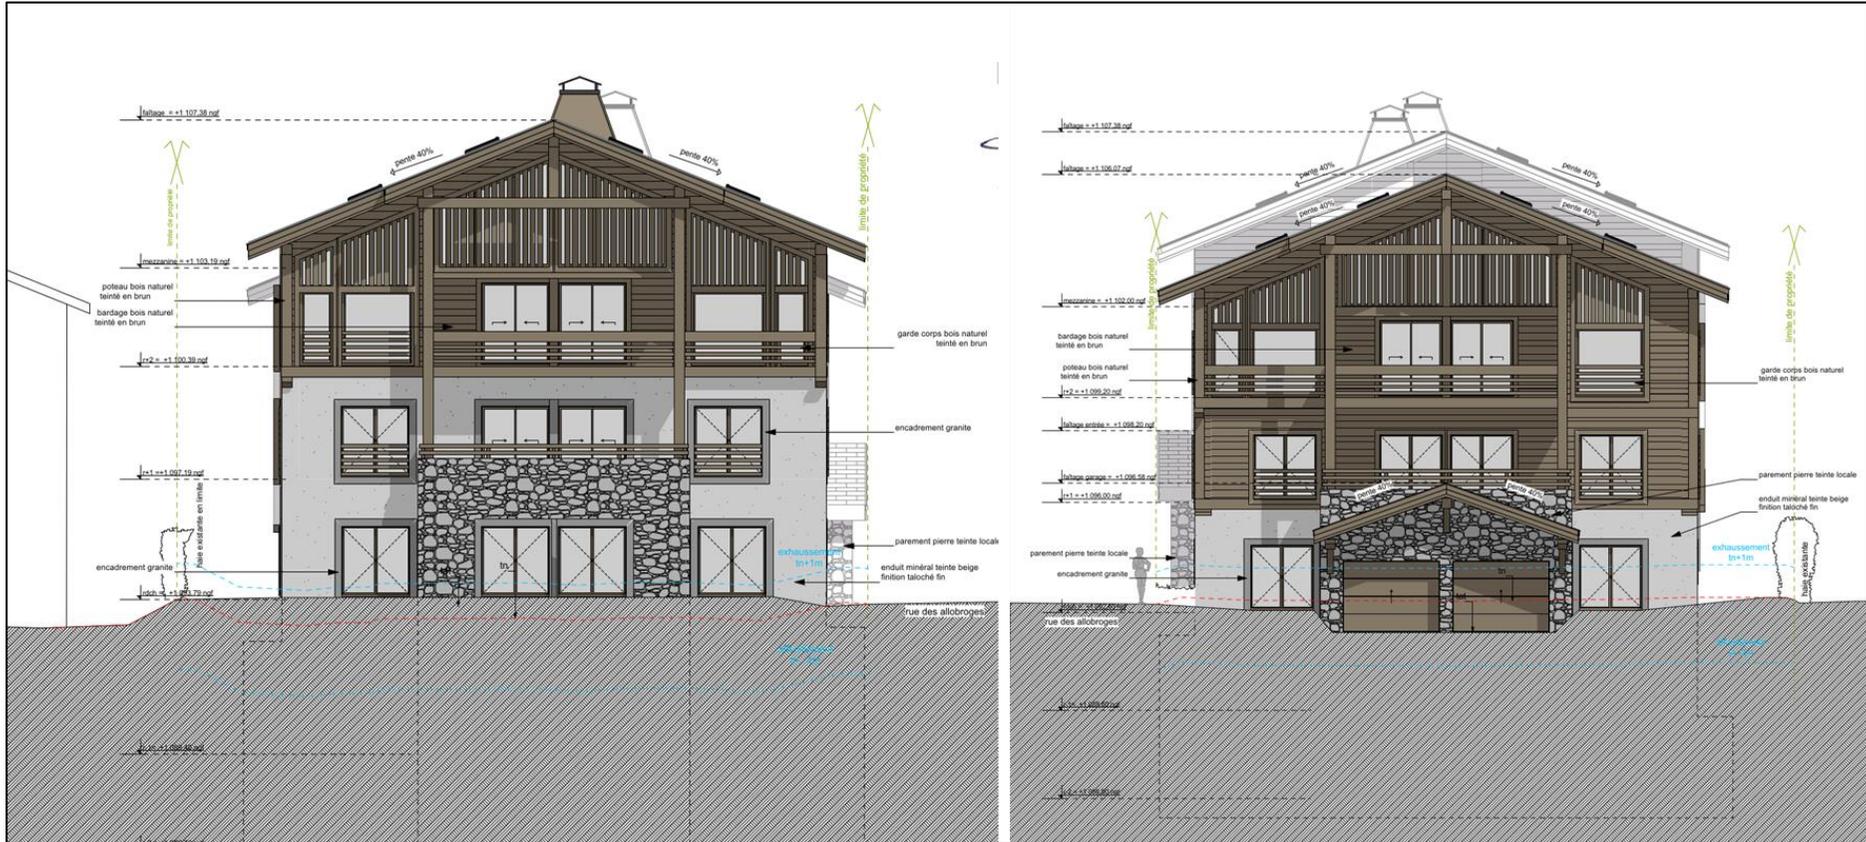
Illustration de la façade sud-ouest (source : Dossier PC haag&baquet)
